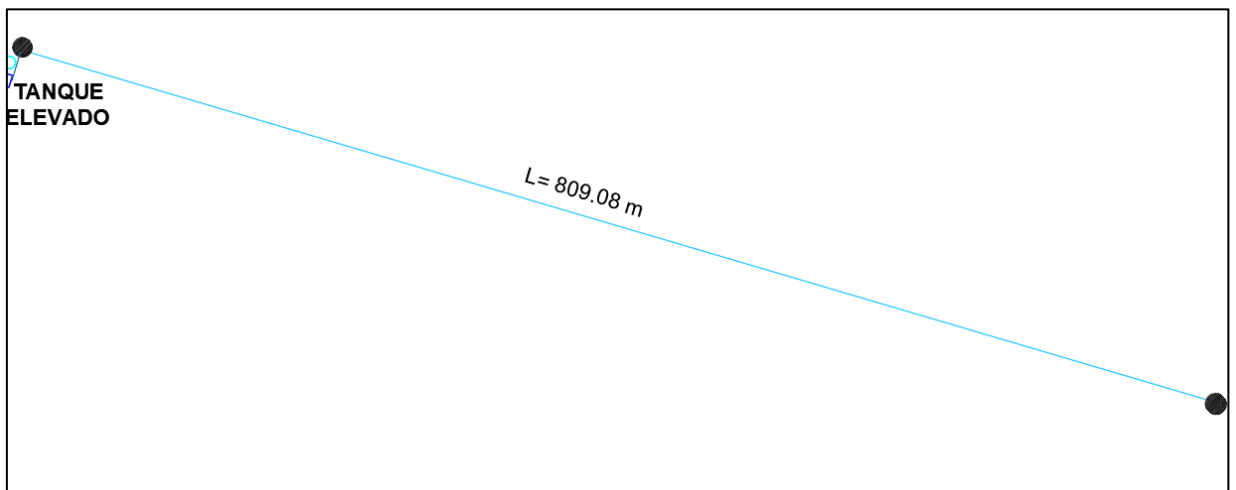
Longitud del Primer Tramo. Propuesta #1
